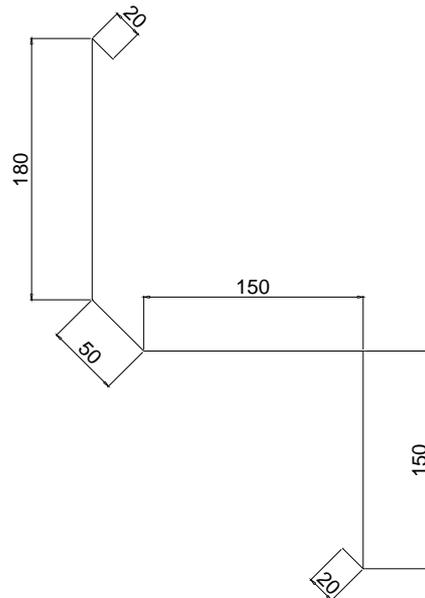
Raccord sur embase de lanterneau ou désenfumage (épaisseur 1 mm)
